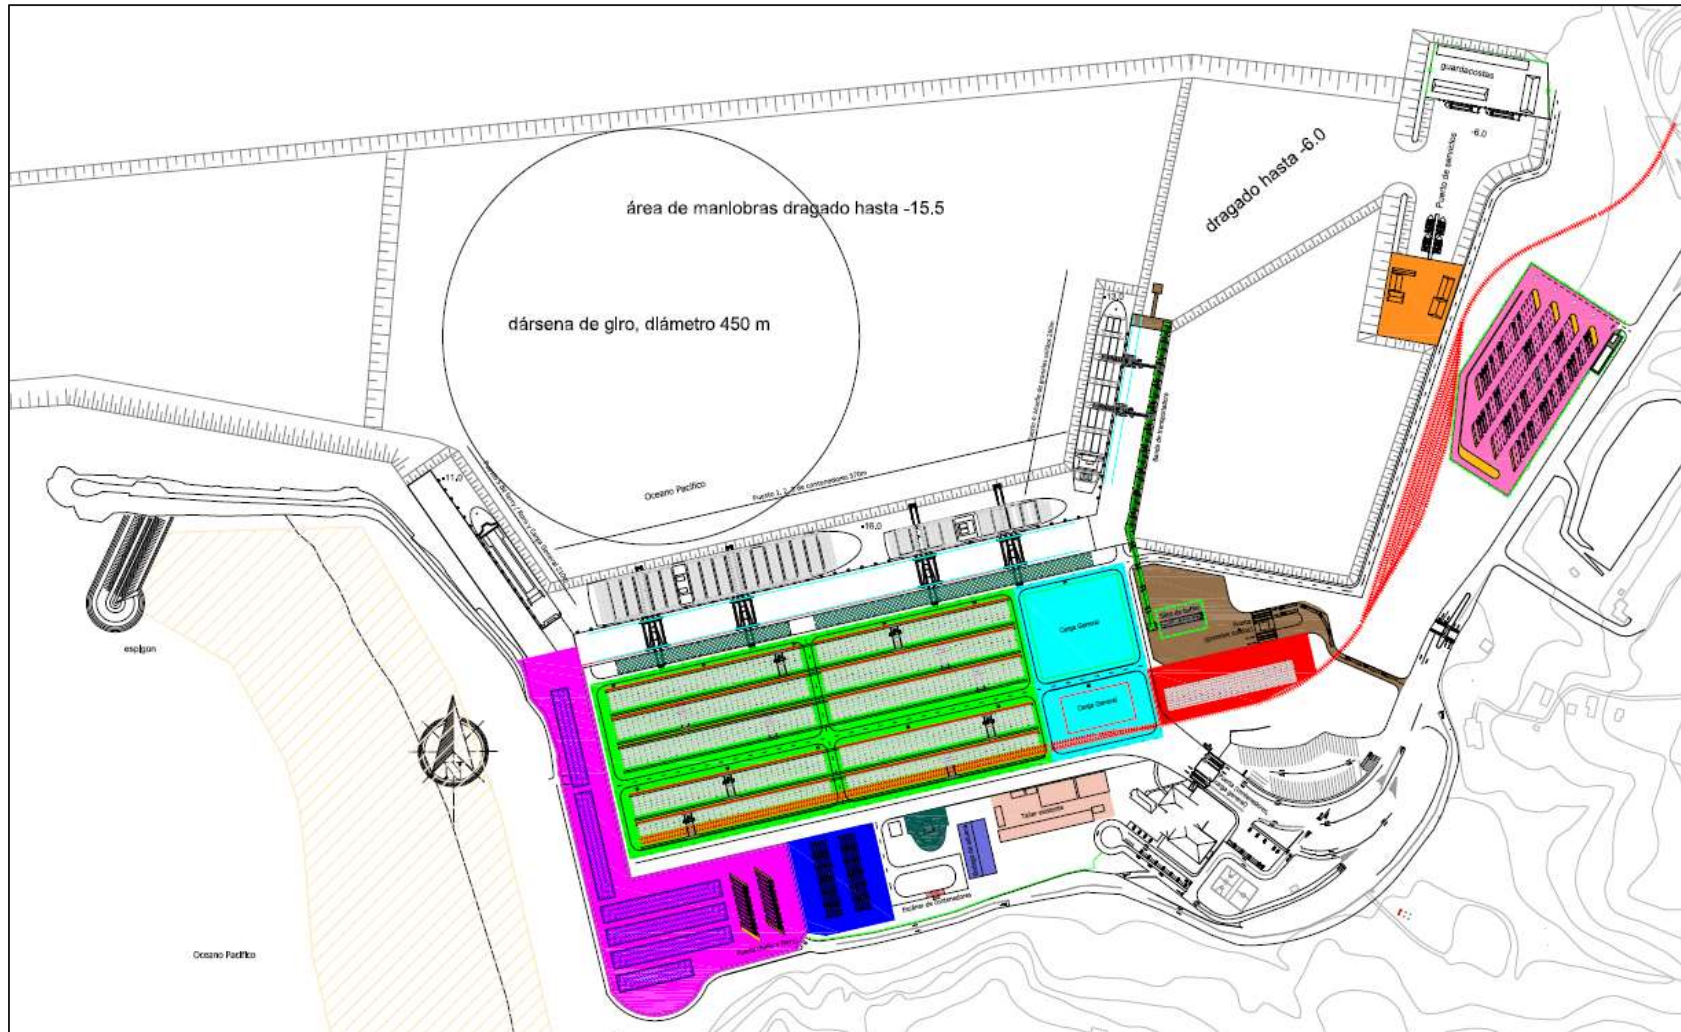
Plan Maestro de Puerto Caldera Fase B
